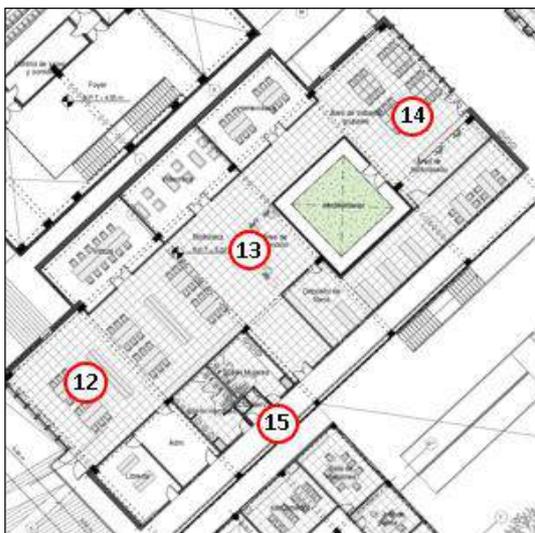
Planta Biblioteca – nivel 2. Obstrucciones interiores
